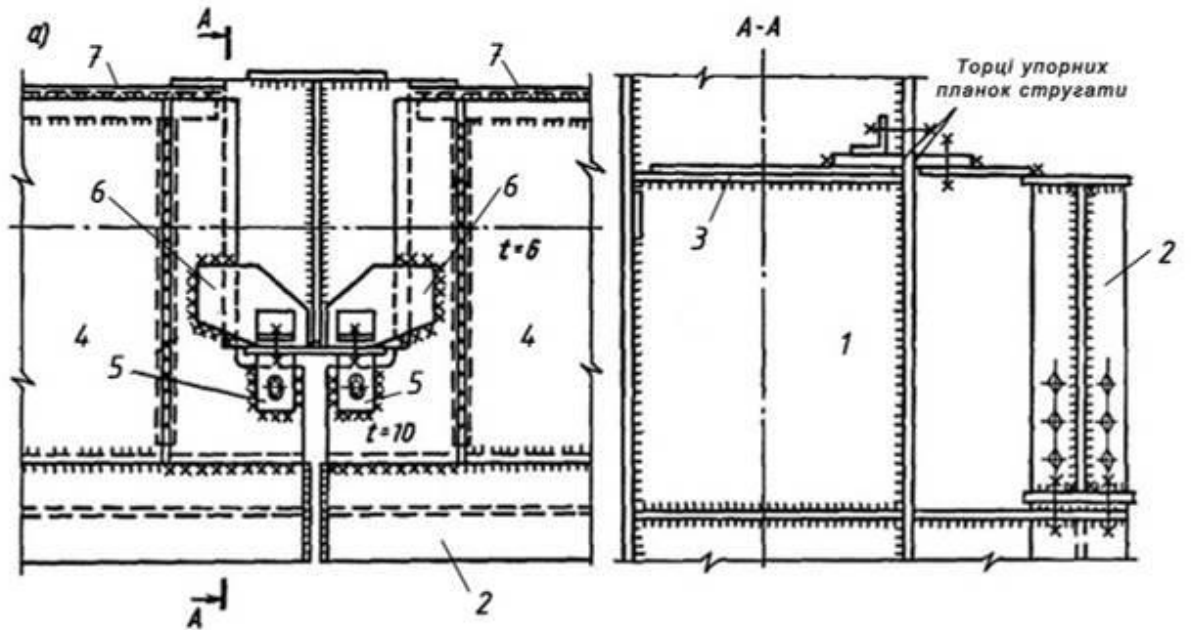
Вузол кріплення підкранових балок до колони з упорними планками:
